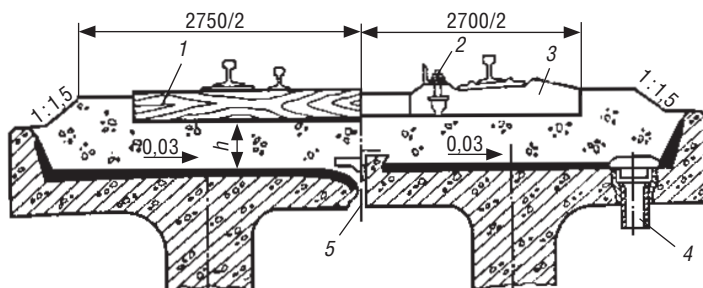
Мостовое полотно с ездой на балласте и железобетонных (справа) и деревянных (слева) шпалах:
